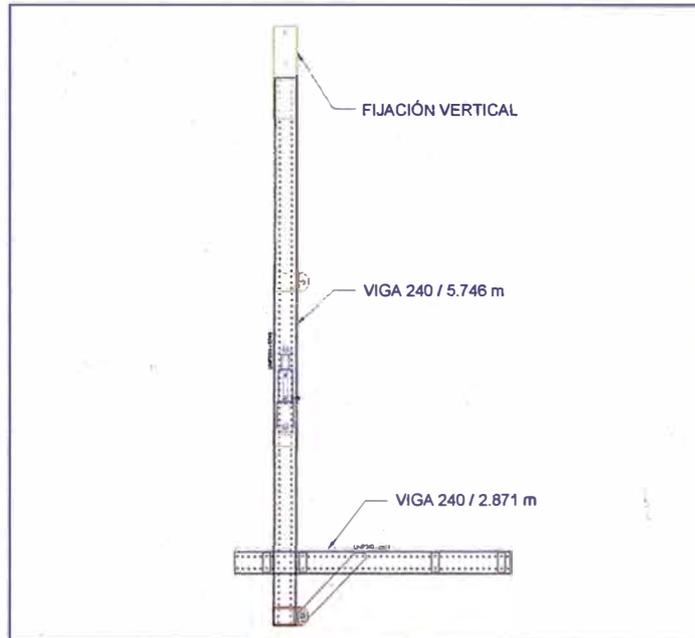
Vista alzado de viga 240 suspendida - Fuente: Elaboración Propia
